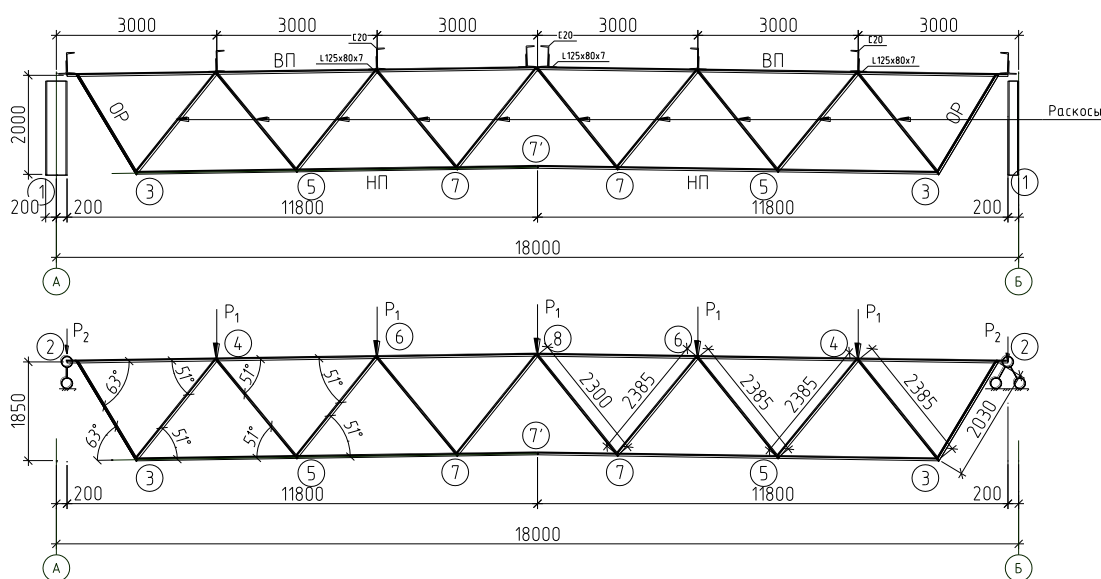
Конструктивная и расчетная схемы фермы
